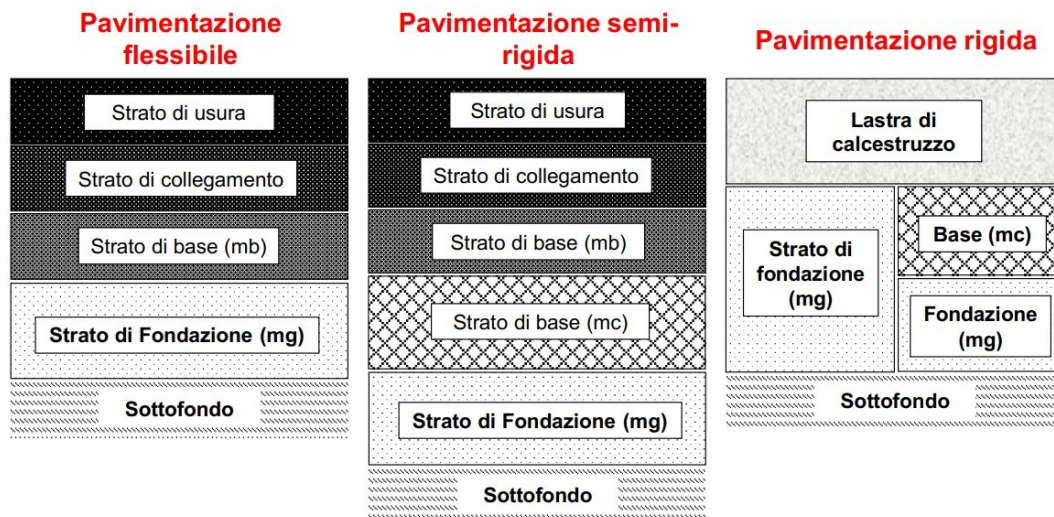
Tipologie costruttive di pavimentazione stradale [1]
